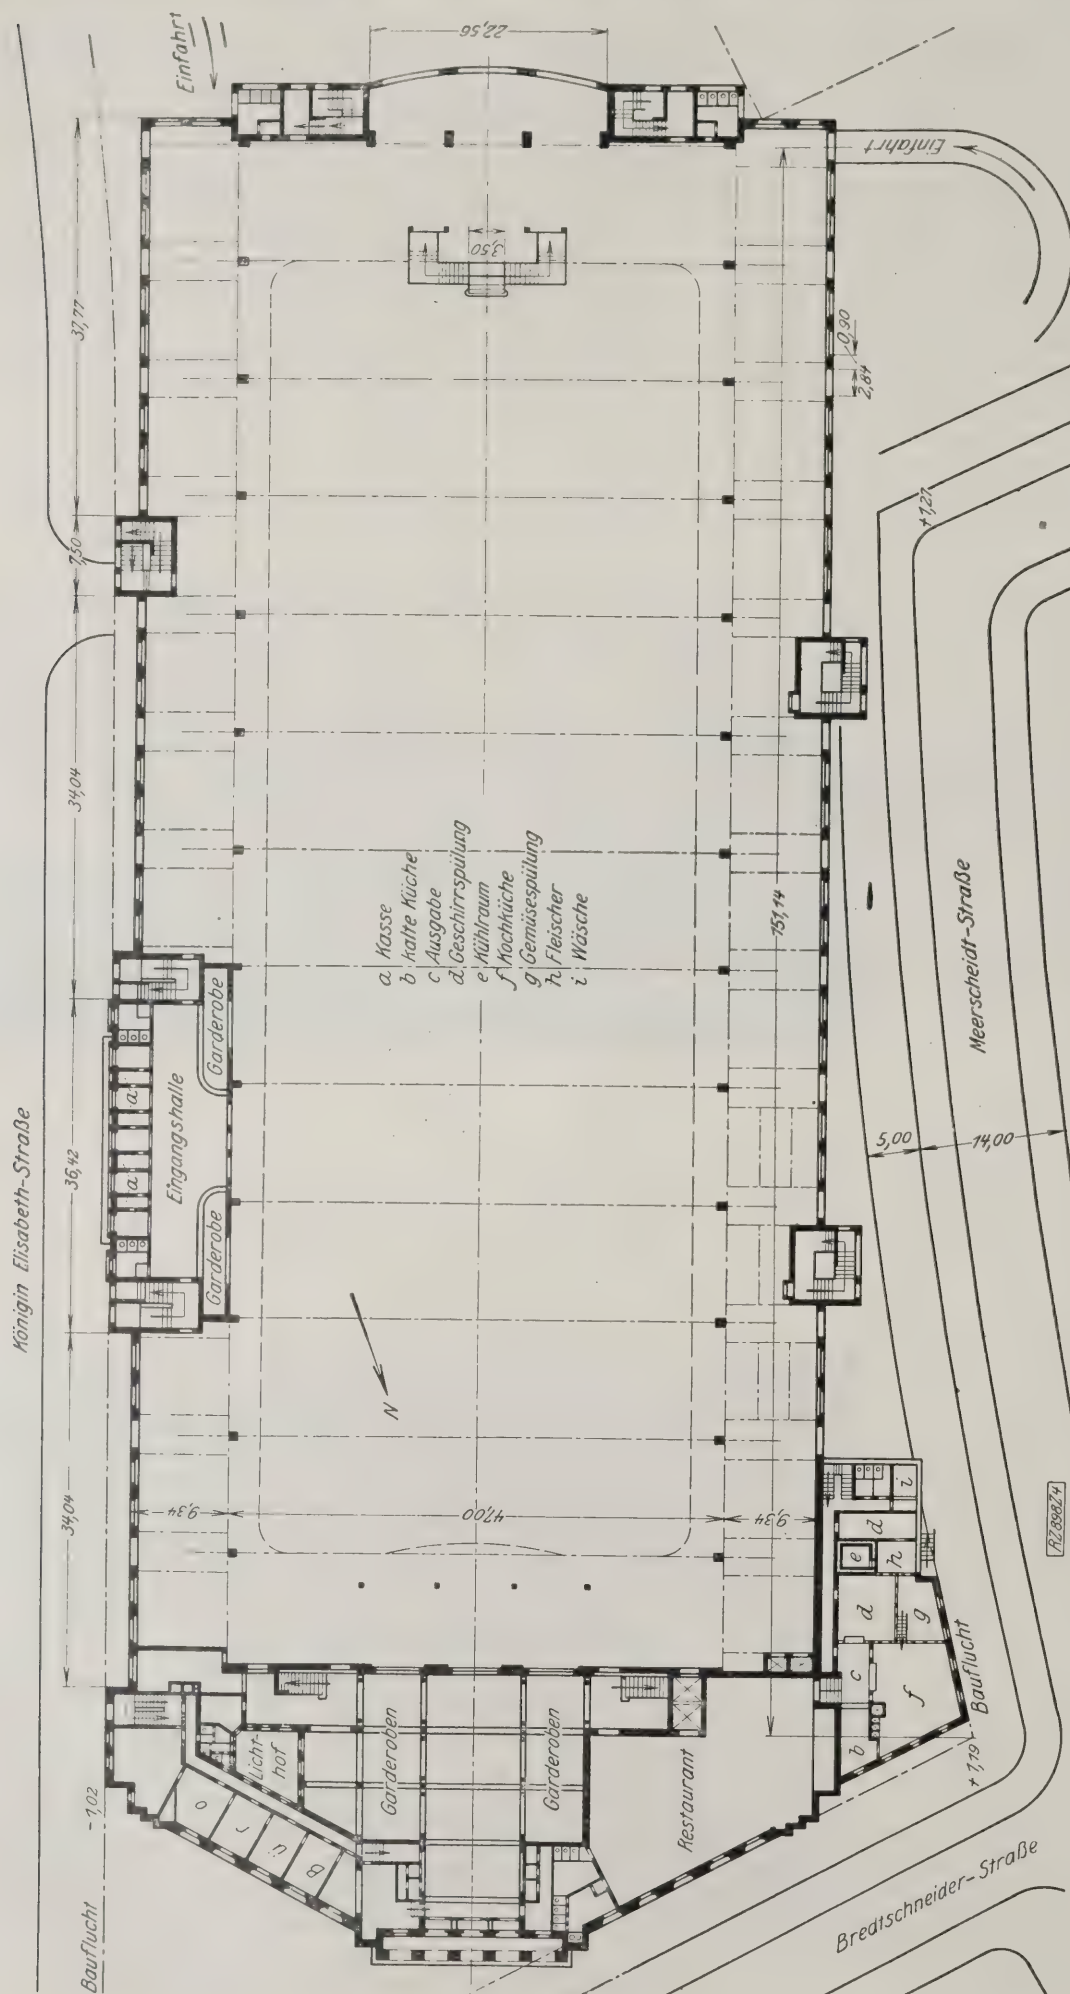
Lageplan und Erdgeschoßgrundriß der neuen Ausstellungshalle.
